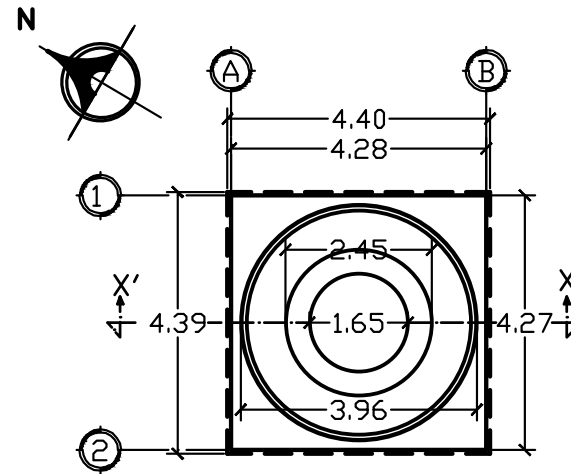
Planta arquitectónica chacuaco Atlihuayan
